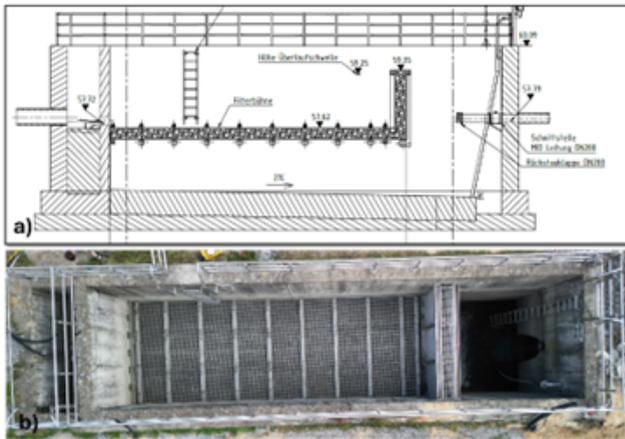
a) Längsschnitt durch das Becken mit eingebautem Filter; b) Draufsicht auf den eingebauten Filter
